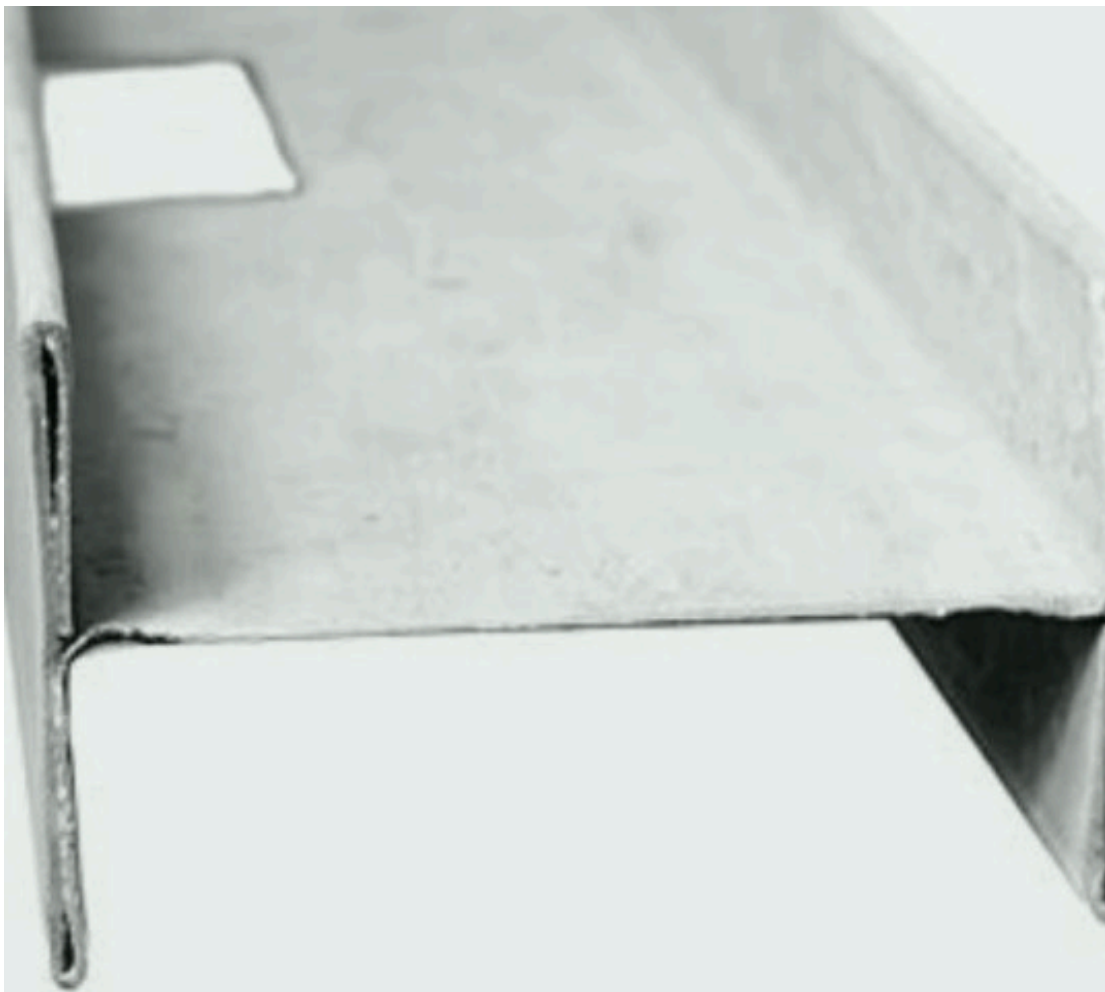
Conector H, Thermorock. Fuente: Sitio web del fabricante.
